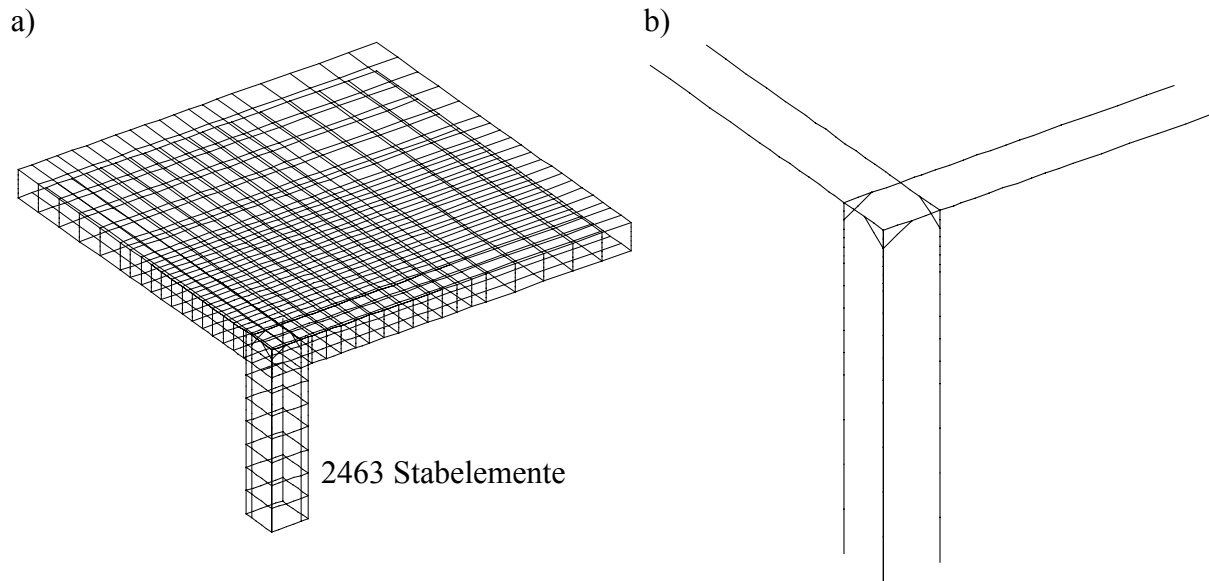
Elementierung des FE-Netzes – Stabelemente: a) gesamtes Bewehrungsnetz, b) Stützenanschlussbewehrung
